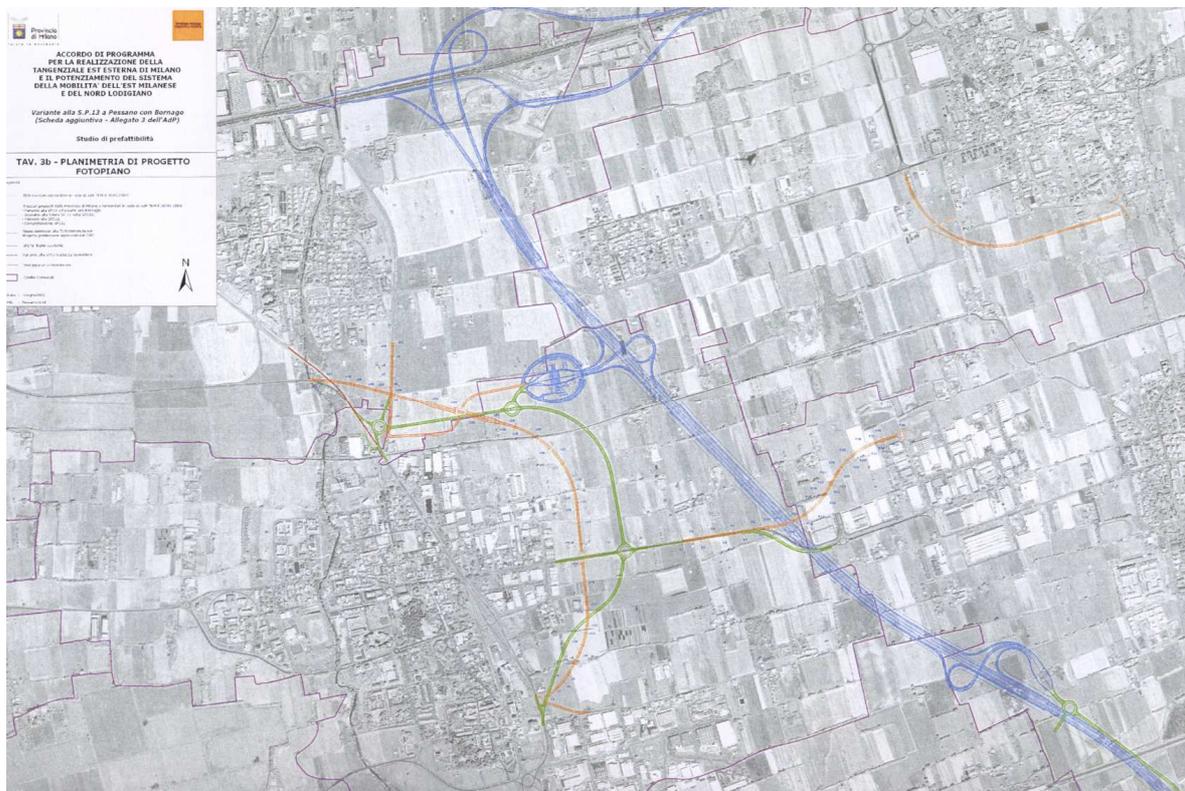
Accordo di Programma per la realizzazione della Tangenziale est Esterna di Milano – Planimetria di progetto fotopiano
